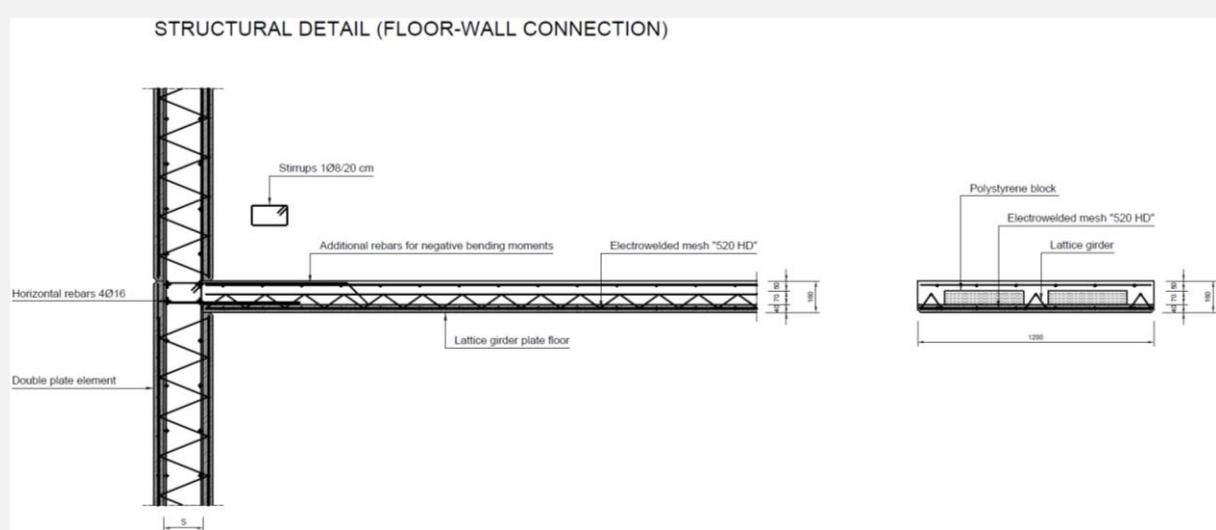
Detaliu structural tipic pentru prindere a pereților din b.a. de placă prefabricată din b.a. (secțiune verticală).
